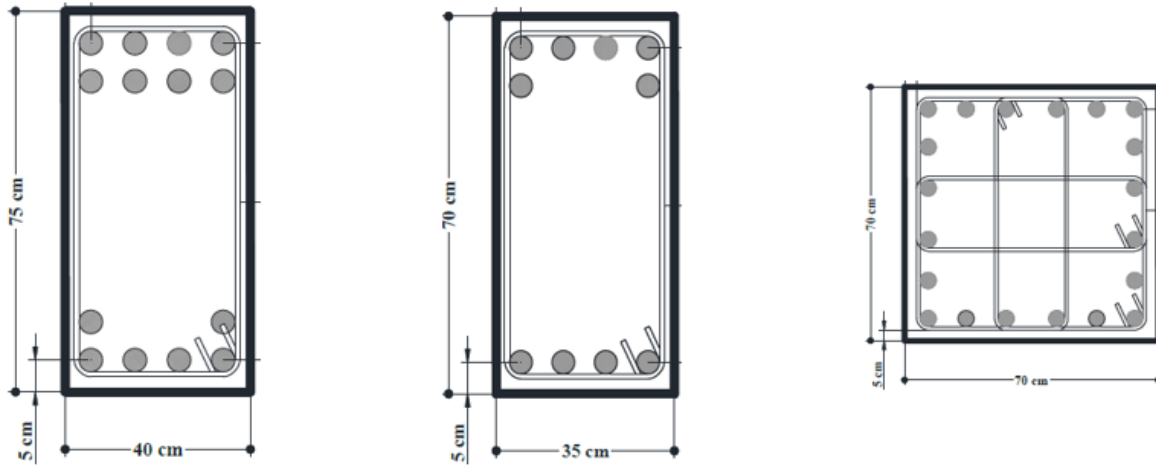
Armado tipo de vigas y columnas de edificio de CR de 6 niveles $Q=2$ (Hernández, 2016)
